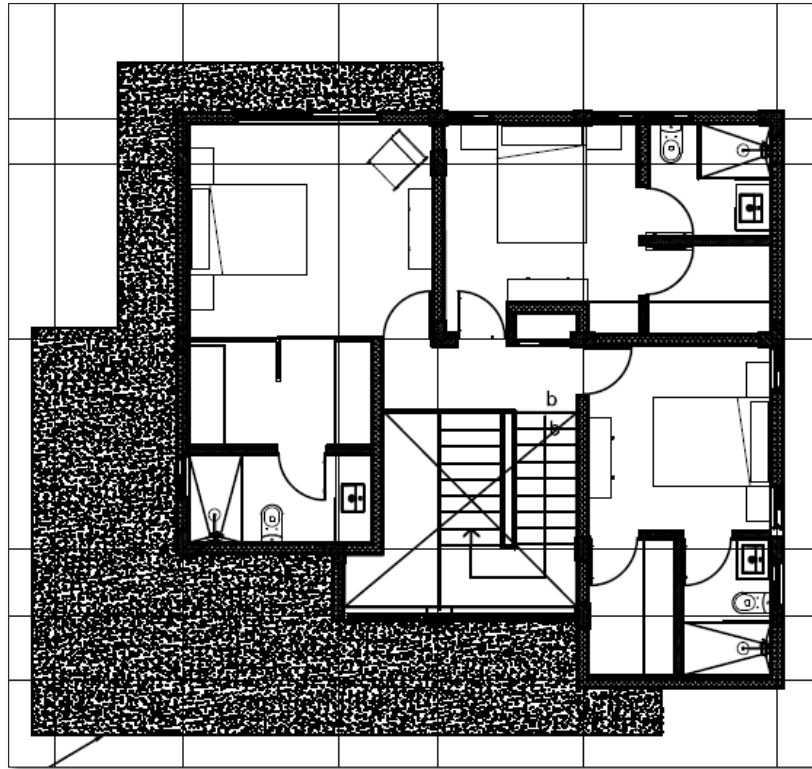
Planta arquitectónica 2do. Nivel.
